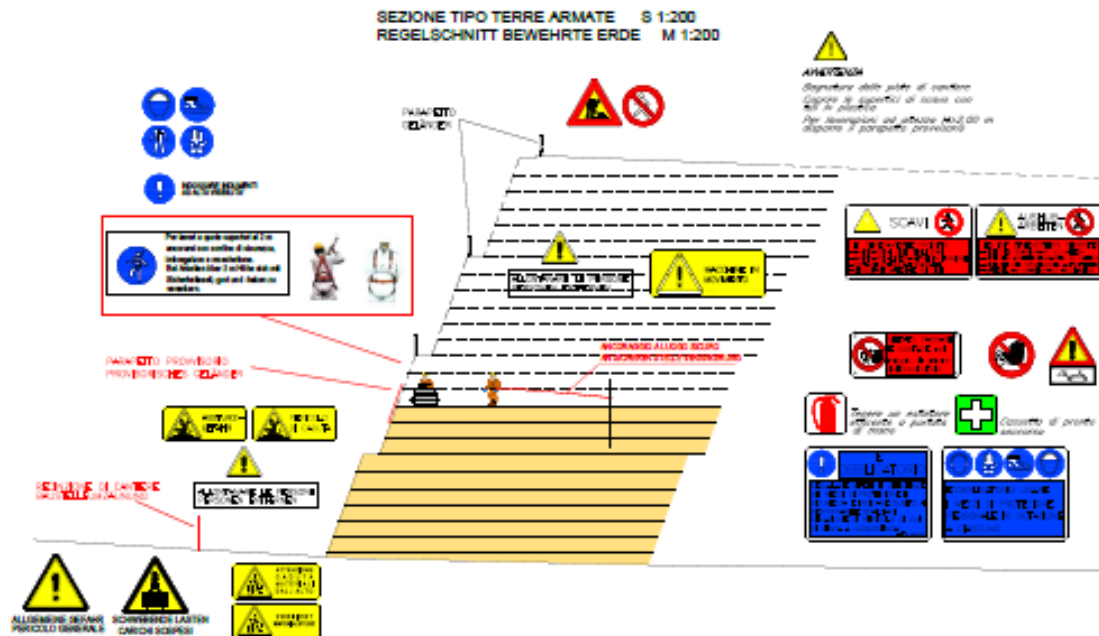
Baustelle Hinterrigger – Regelquerschnitt bewehrte Erde.
